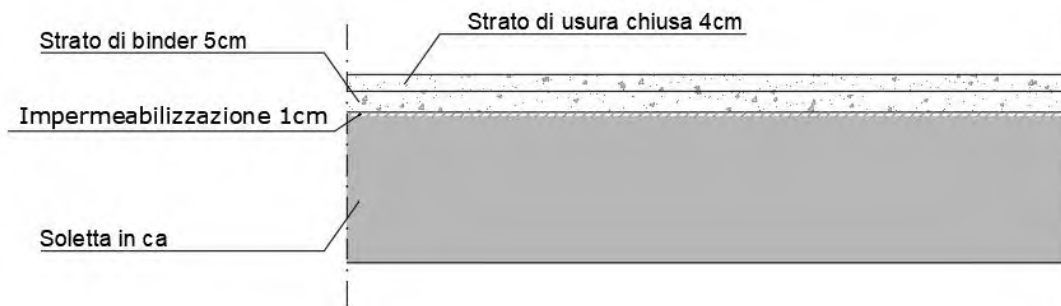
Composizione sovrastruttura per le rampe di svincolo su impalcato – TIPO P1C
